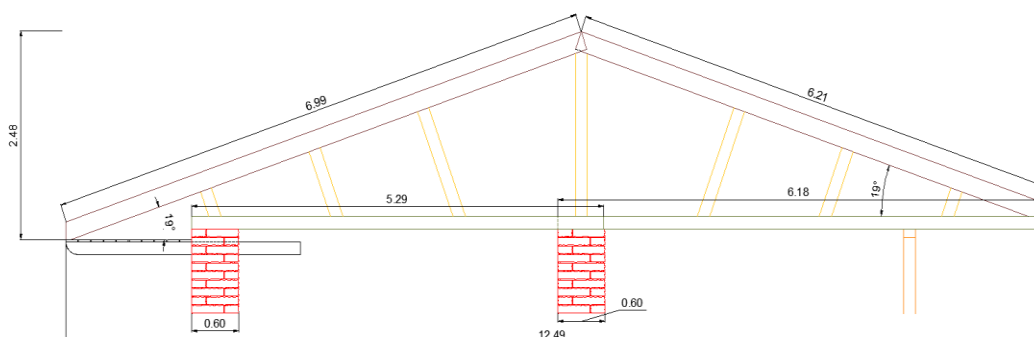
Sistema de Armadura de Cubierta. Fuente: (Corradine, 2008)
